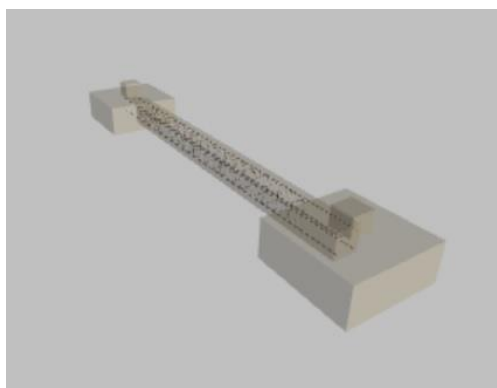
Imagen 3D de una viga de atado de la estructura. Fuente: CYPE 3D.
